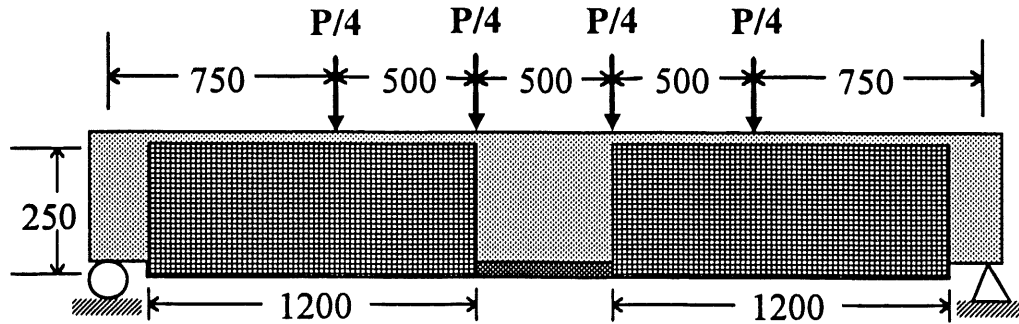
Poutre P2 avec ancrages en U bidirectionnels et chargement distribué
